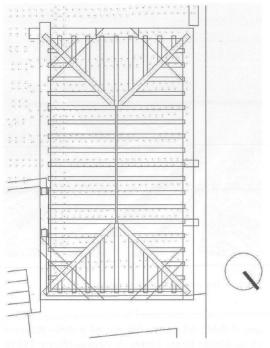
Recreación de la planta de la armadura de la cubierta (dibujo del autor 2013)
